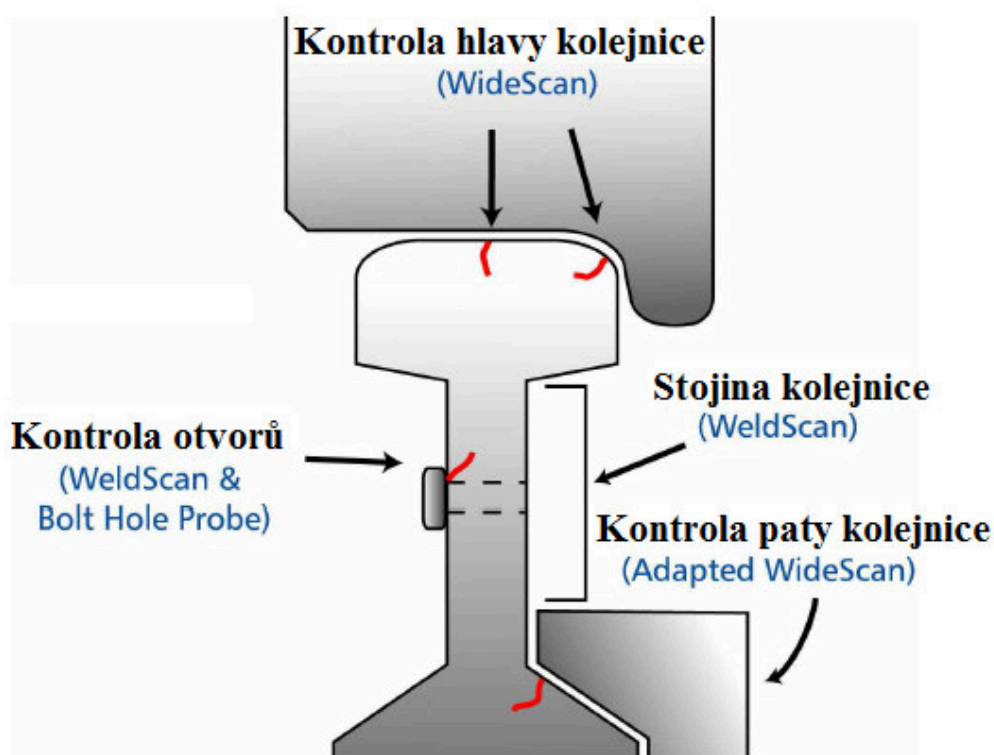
Zkouška vířivými proudy na zkušebním vzorku [6]
